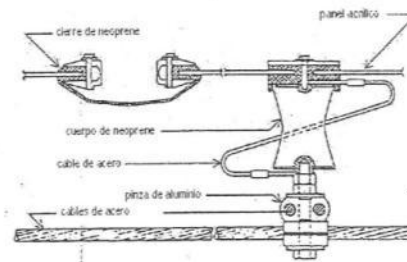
f: Detalle del encuentro de las placas de acrílico y los cables.
